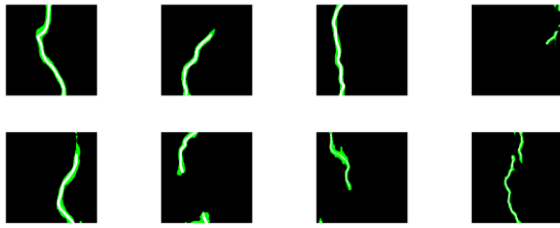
学習済みのDeepLabv3+ResNet18によるひび割れ推論
